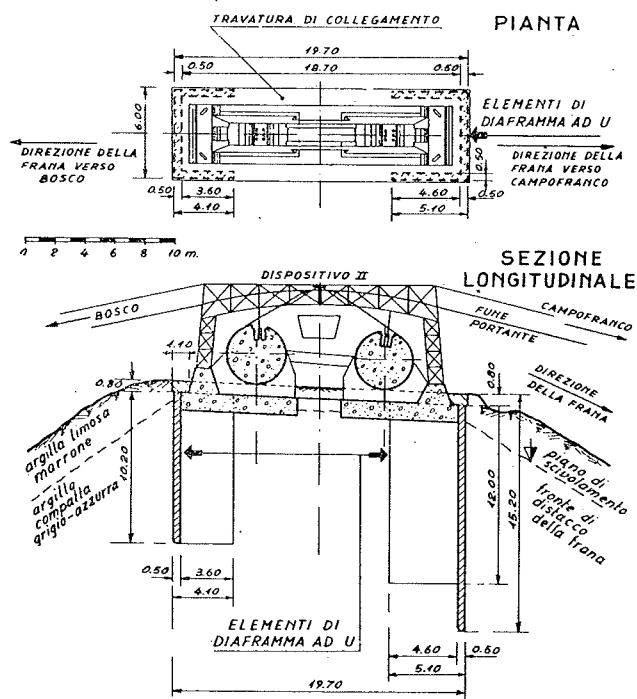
Elementi ad U di diaframma collegati superiormente da una travatura a protezione del dispositivo II
